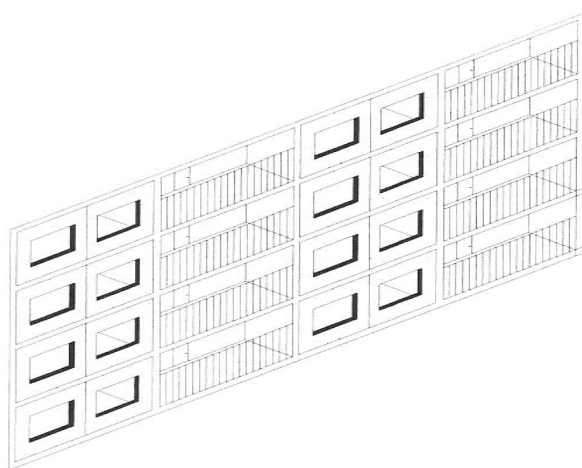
Exemplo de painel de concreto do tipo vedação, onde a estrutura fica aparente (PRECON, em www.precon.br).
